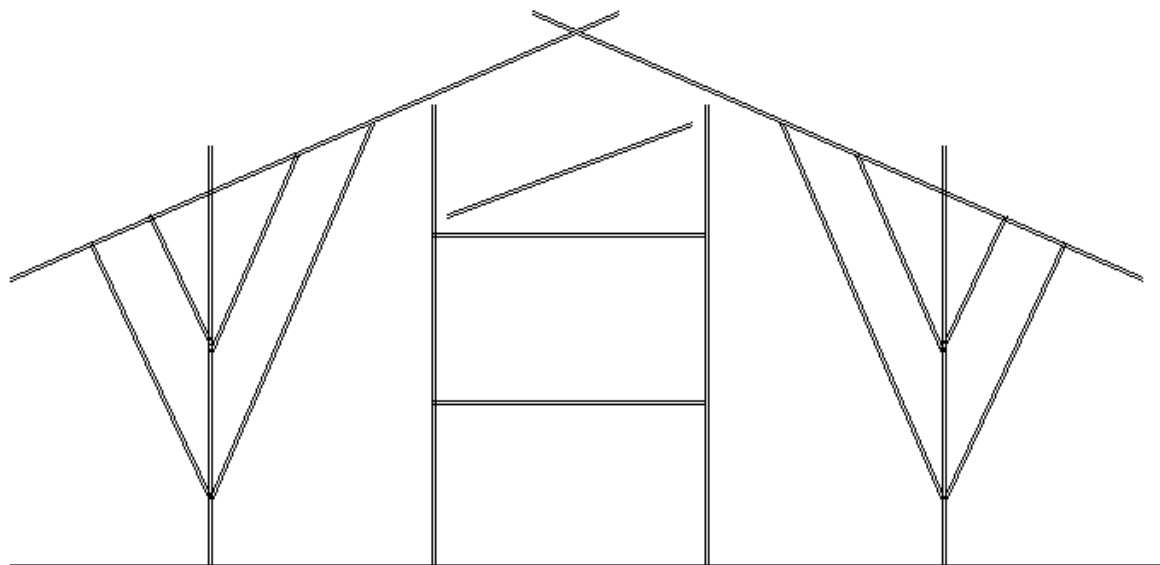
Elevação (esquemática) – sistema estrutural proposto pela arquitetura.
